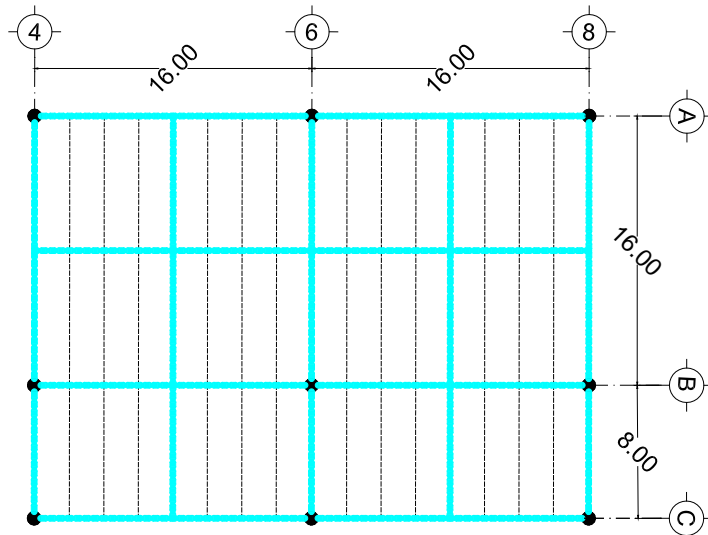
Claro más desfavorable para dimensionamiento de vigas y columnas
